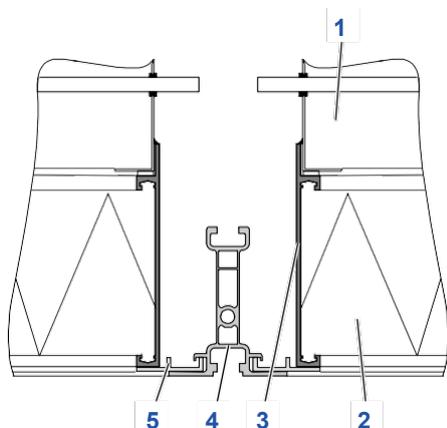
Fixez le filtre HEPA/ULPA dans la grille de plafond (l'exemple montre un CAMGRID FFU)
